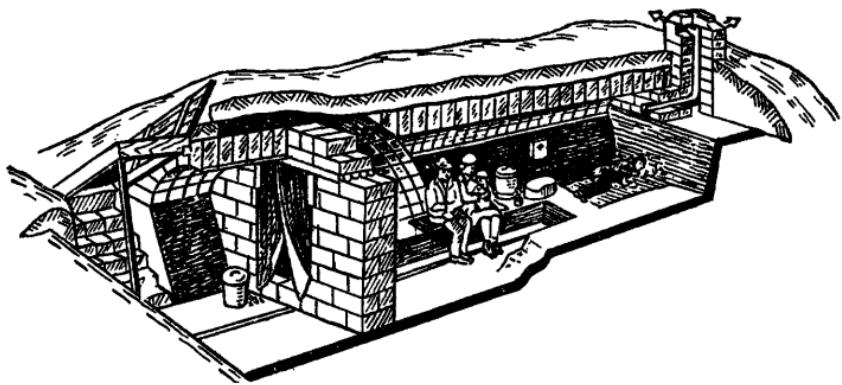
Укрытие без одежды крутостей со сводом из саманных (грунтовых) блоков (ослабляет действие радиации в 400—600 раз; устраивается в южных безлесных районах)
